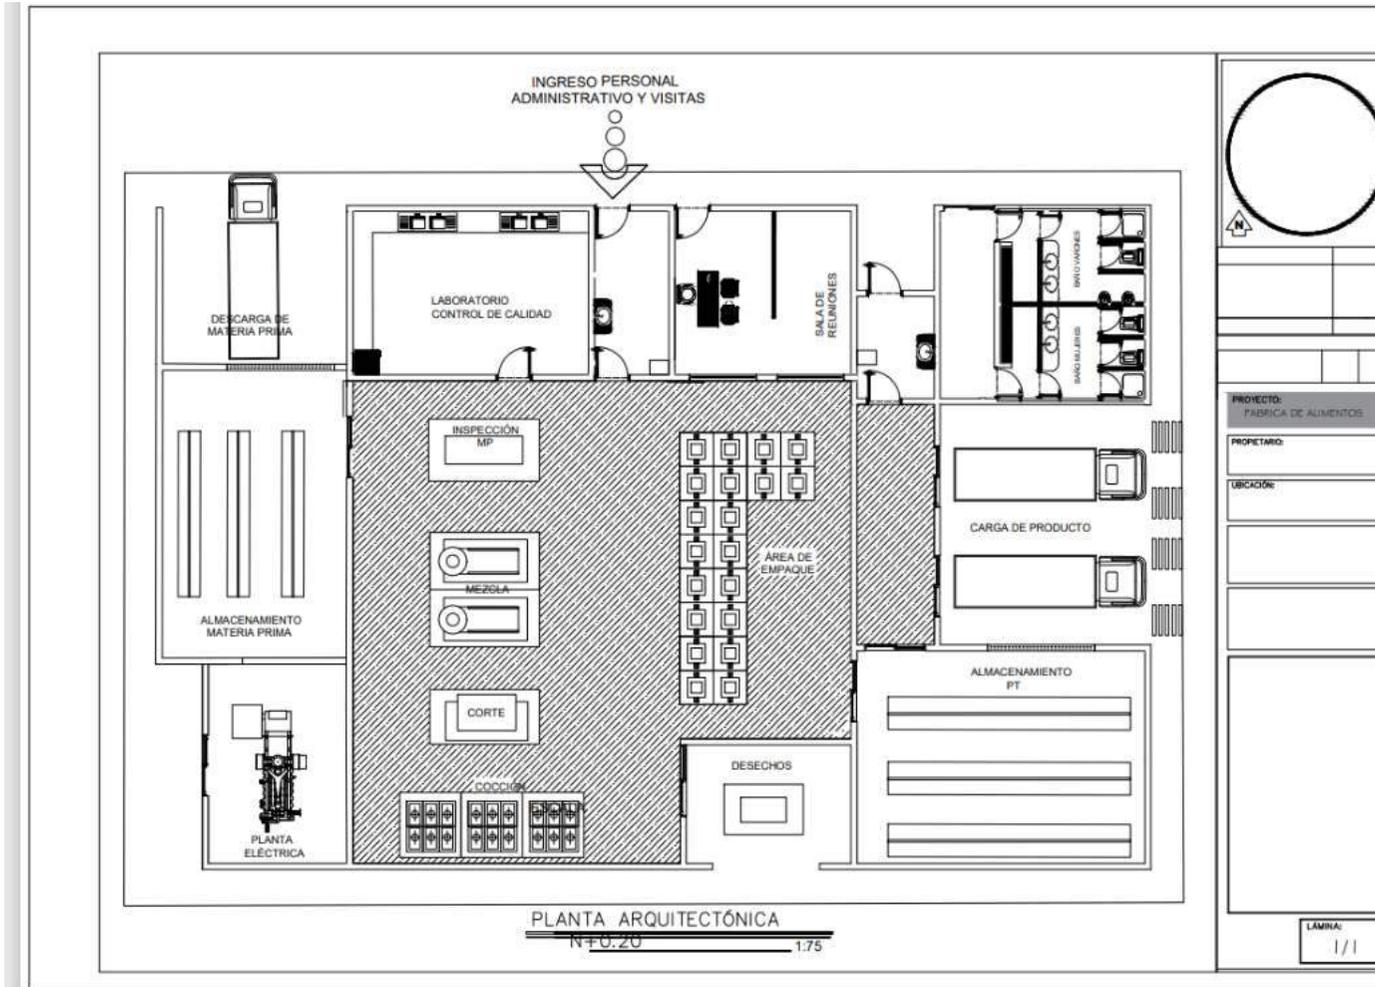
Layout* de la planta y de las dependencias planeado en un área de 300 m<sup>2</sup>
